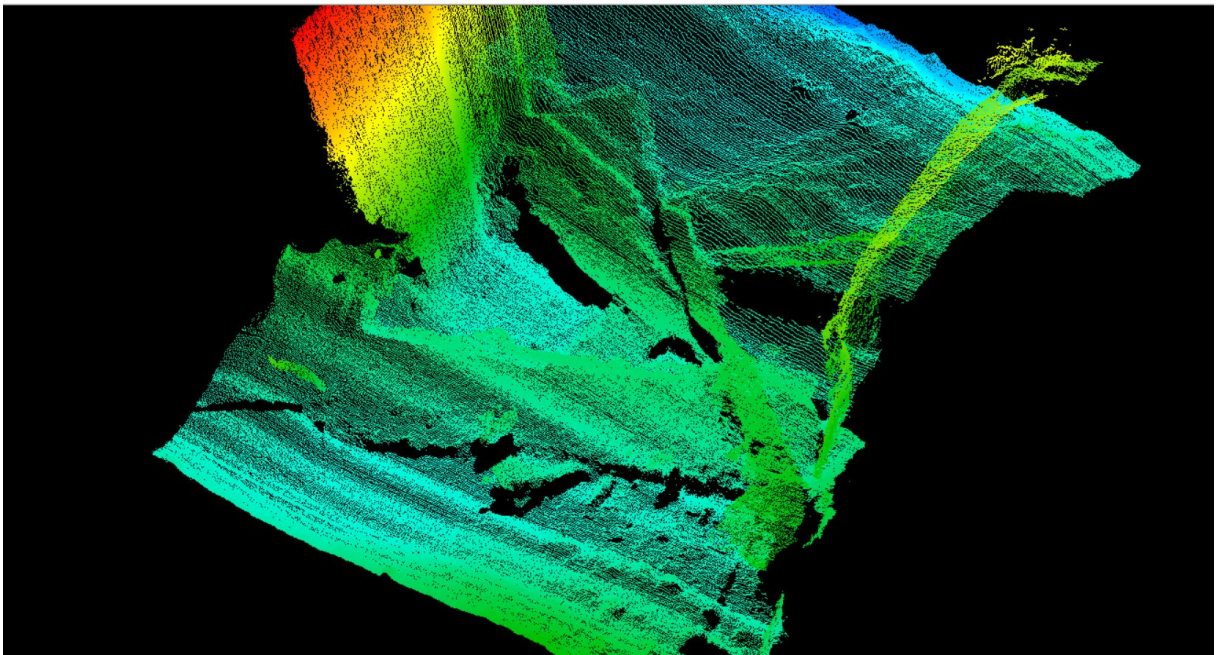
Vigas y tablero del vano P5-P6 colapsados entre ambas pilas.
